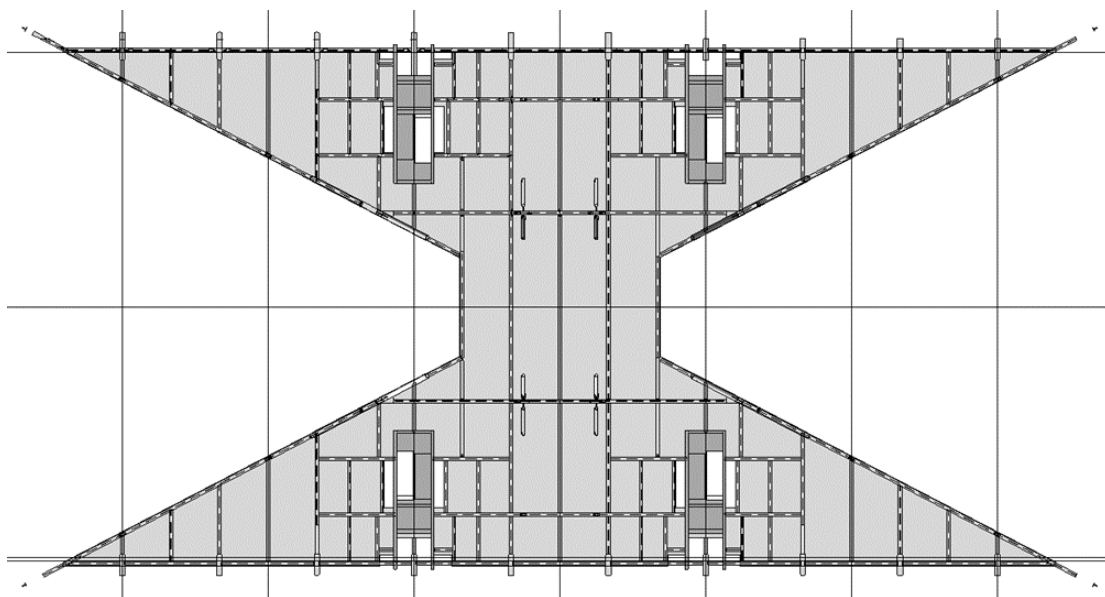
Impalcato LC1, modulo Nord: vista in pianta
